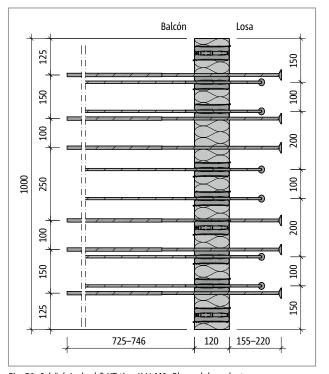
Schöck Isokorb® XT tipo K-U-M2: Plano del producto
